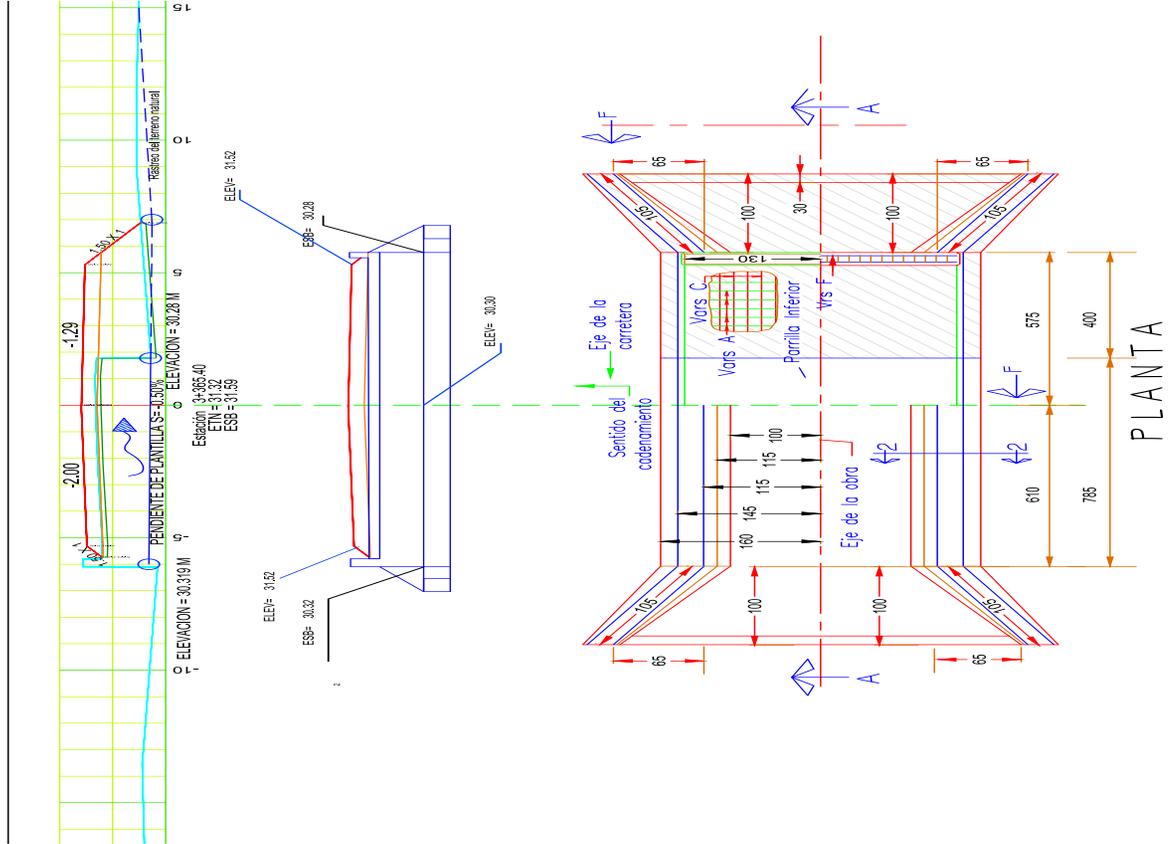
Sección estructural en planta para losas de 2 x 0.85 metros
